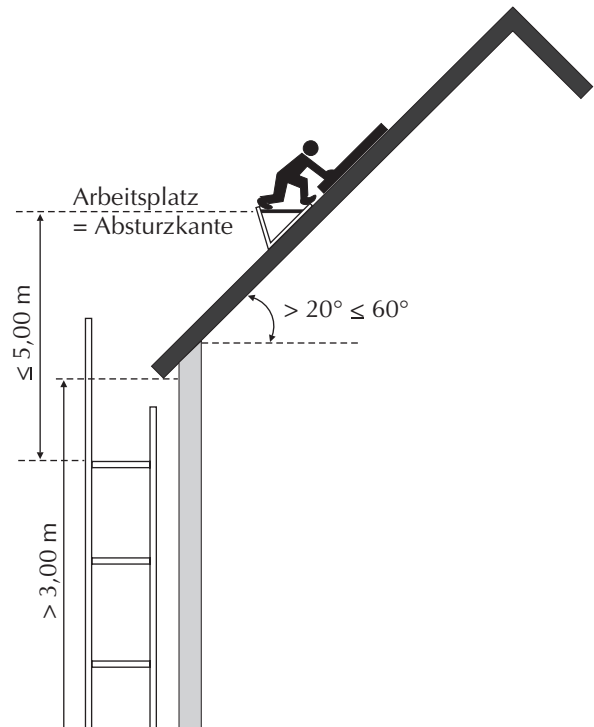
Dachfanggerüste für Arbeiten auf geneigten Dachflächen.
